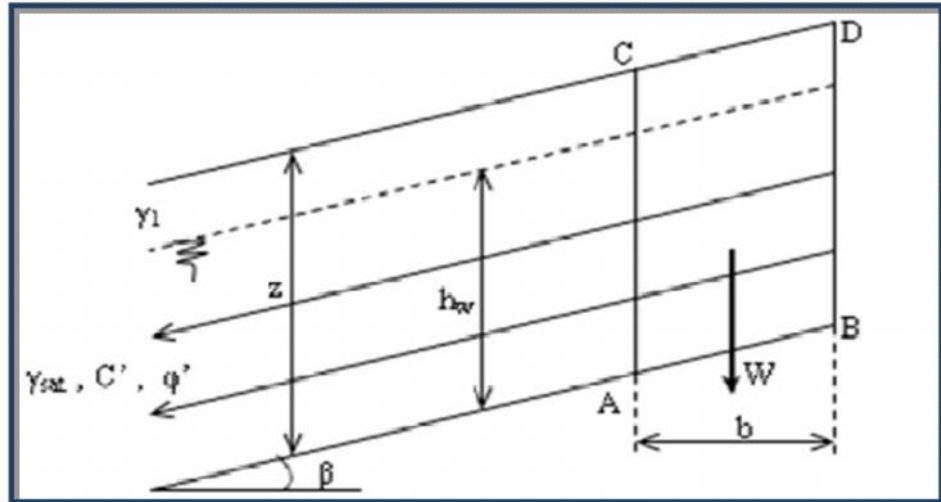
Cas général d'un glissement plan avec effet de l'eau.
